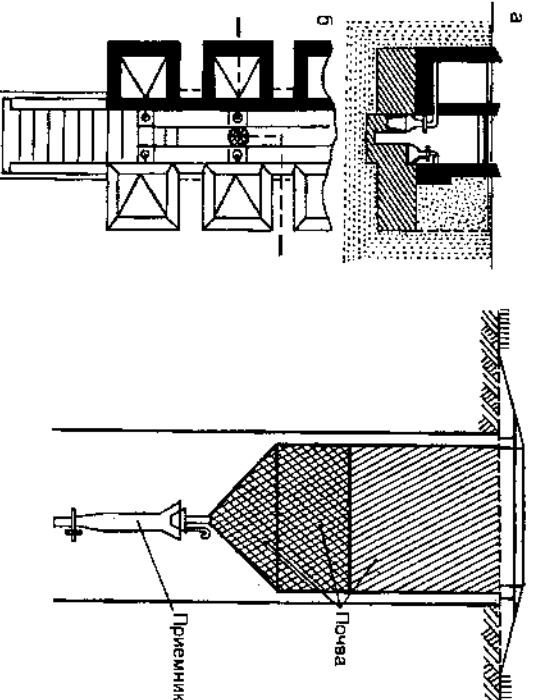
Насыпные бетонные лизиметры: а – вертикальный разрез; б – горизонтальный разрез.
